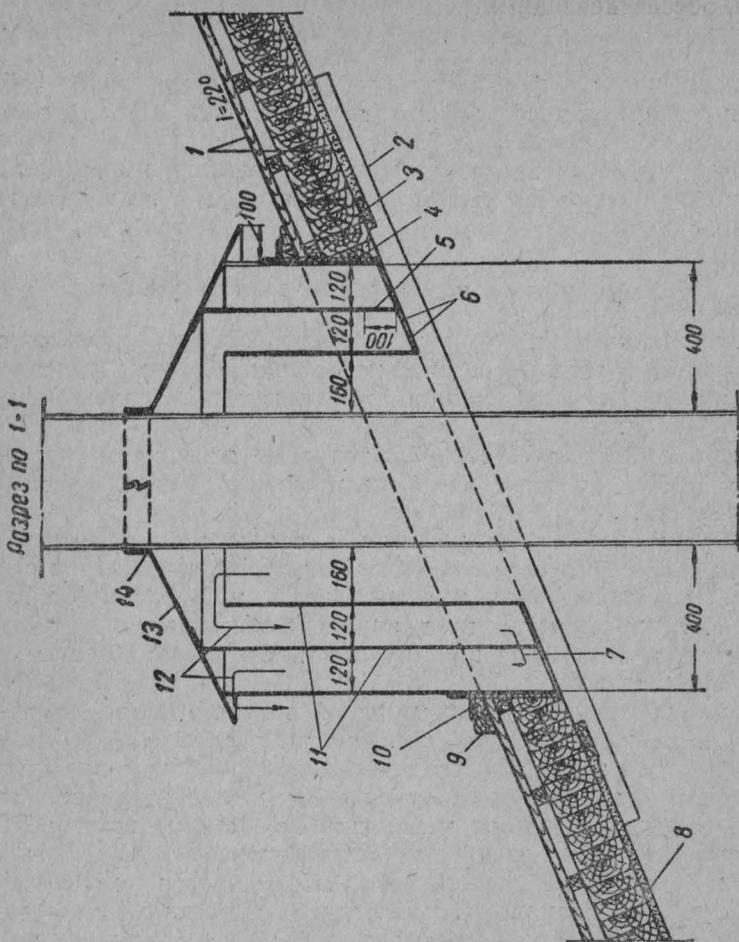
Устройство воздушной разделки при пропуске дымовой трубы через покрытие-перекрытие.
